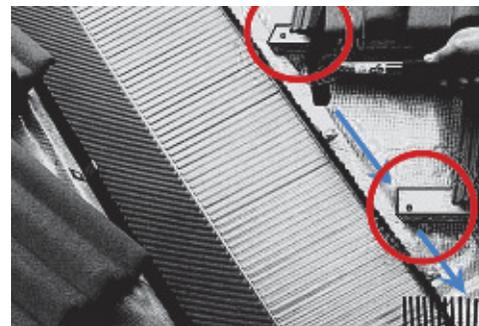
Грубая ошибка: обрешётка закреплена гвоздями вдоль водоотводящего желобка по краям настила ендовы. Попадание влаги под гидроизоляцию гарантировано
